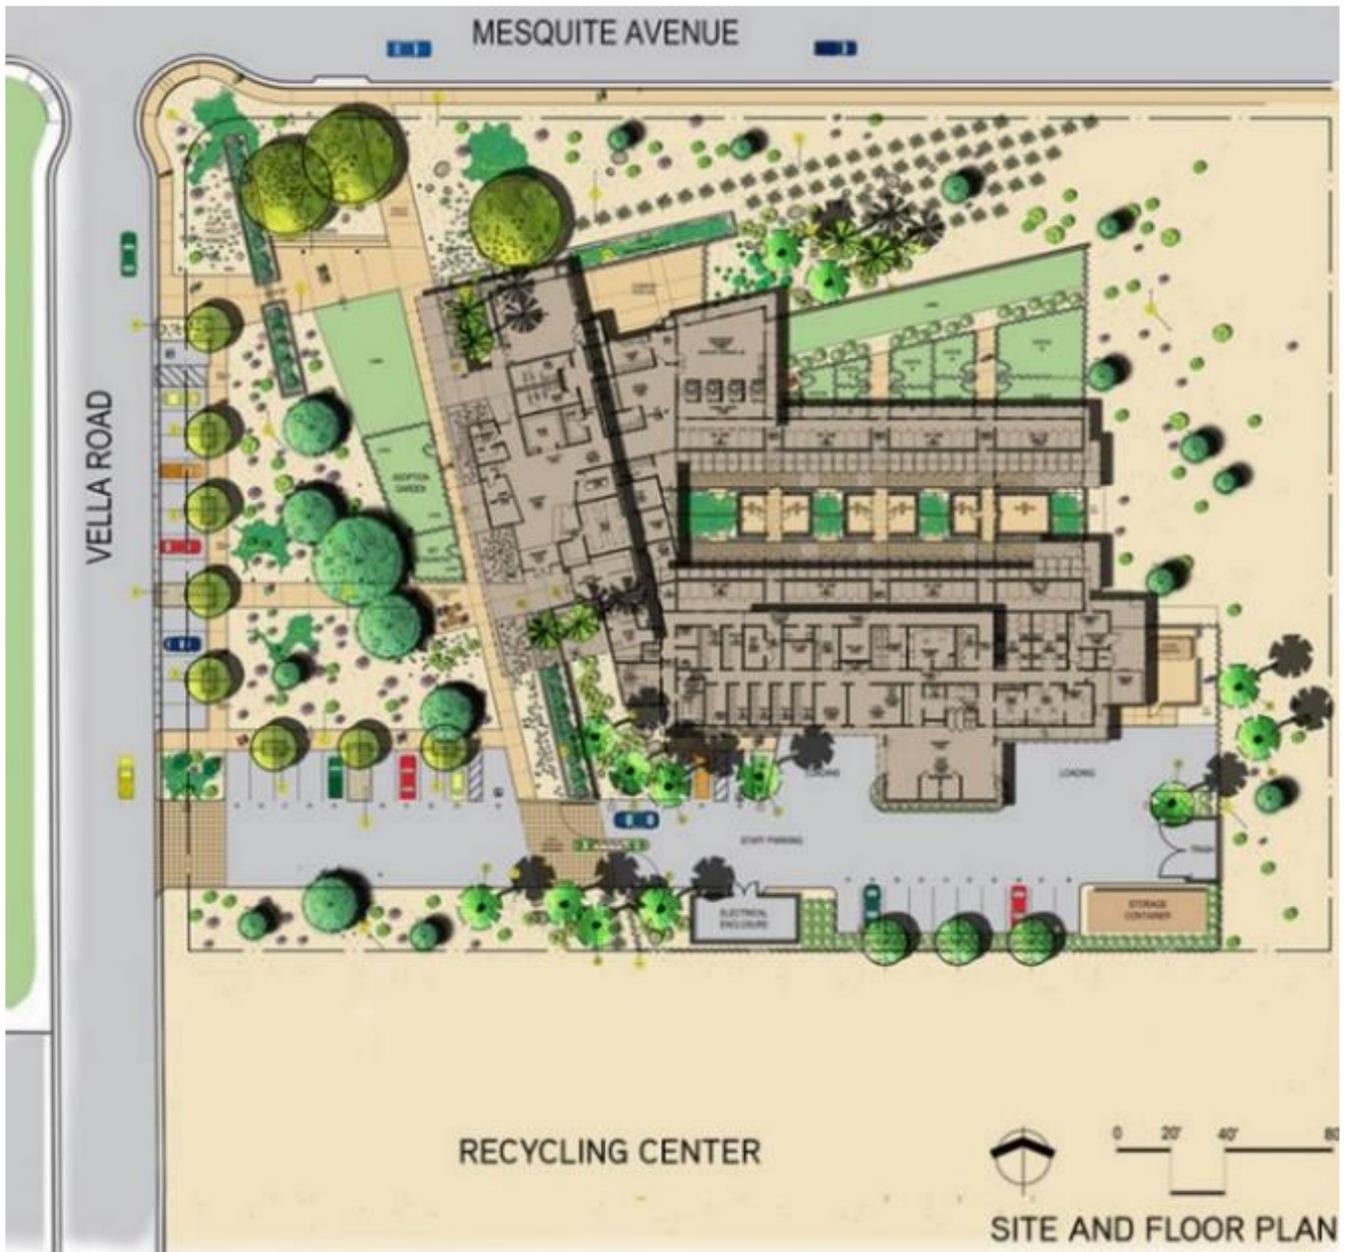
Planta arquitectónica del Centro de Cuidado de Animales
